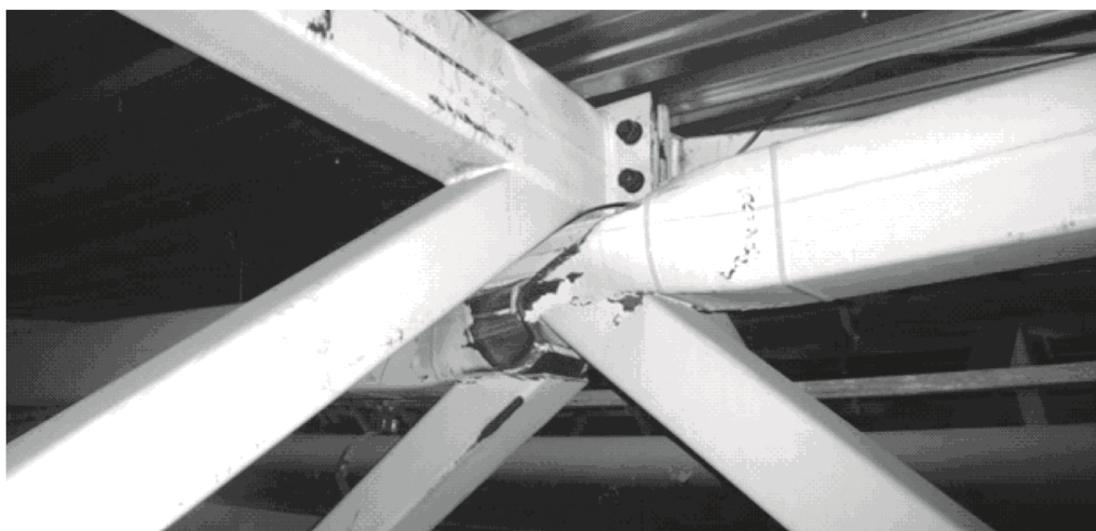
Общий вид разрушения узлов подстропильных ферм в месте опирания стропильных ферм
